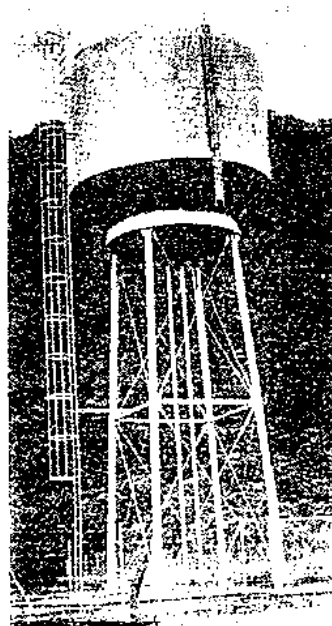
Estanque metálico elevado L. El Valle, Estado Bolívar, Venezuela.
